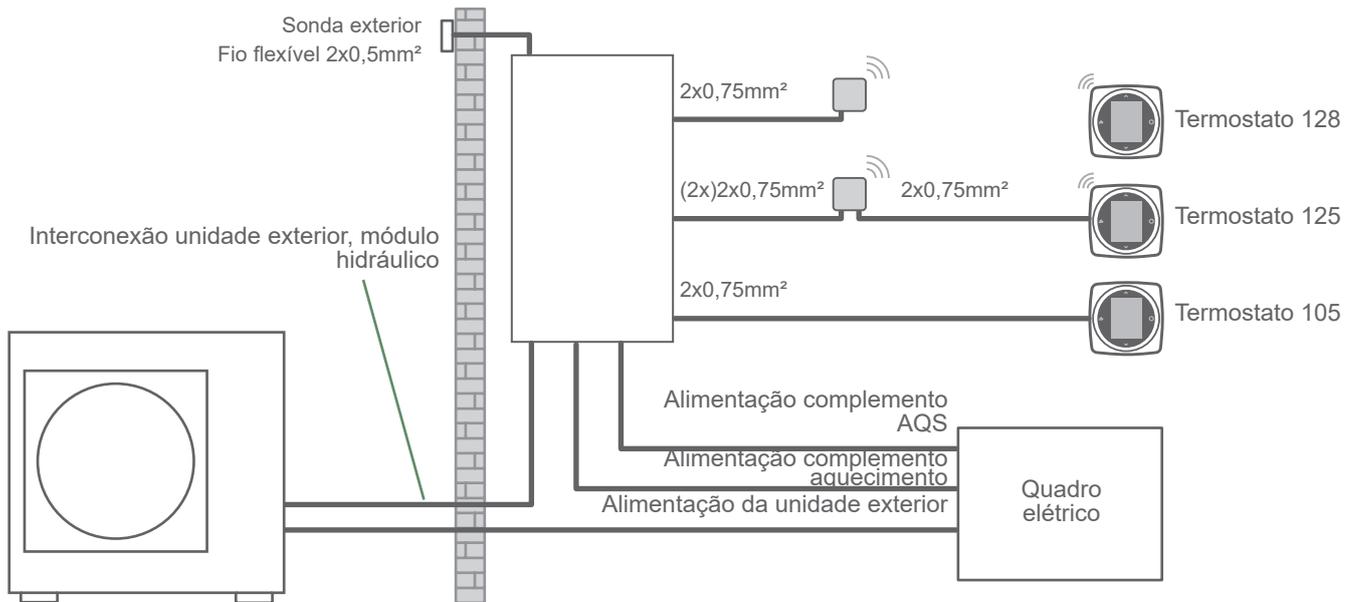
Esquema de conjunto das ligações elétricas para uma instalação simples (1 circuito de aquecimento)
